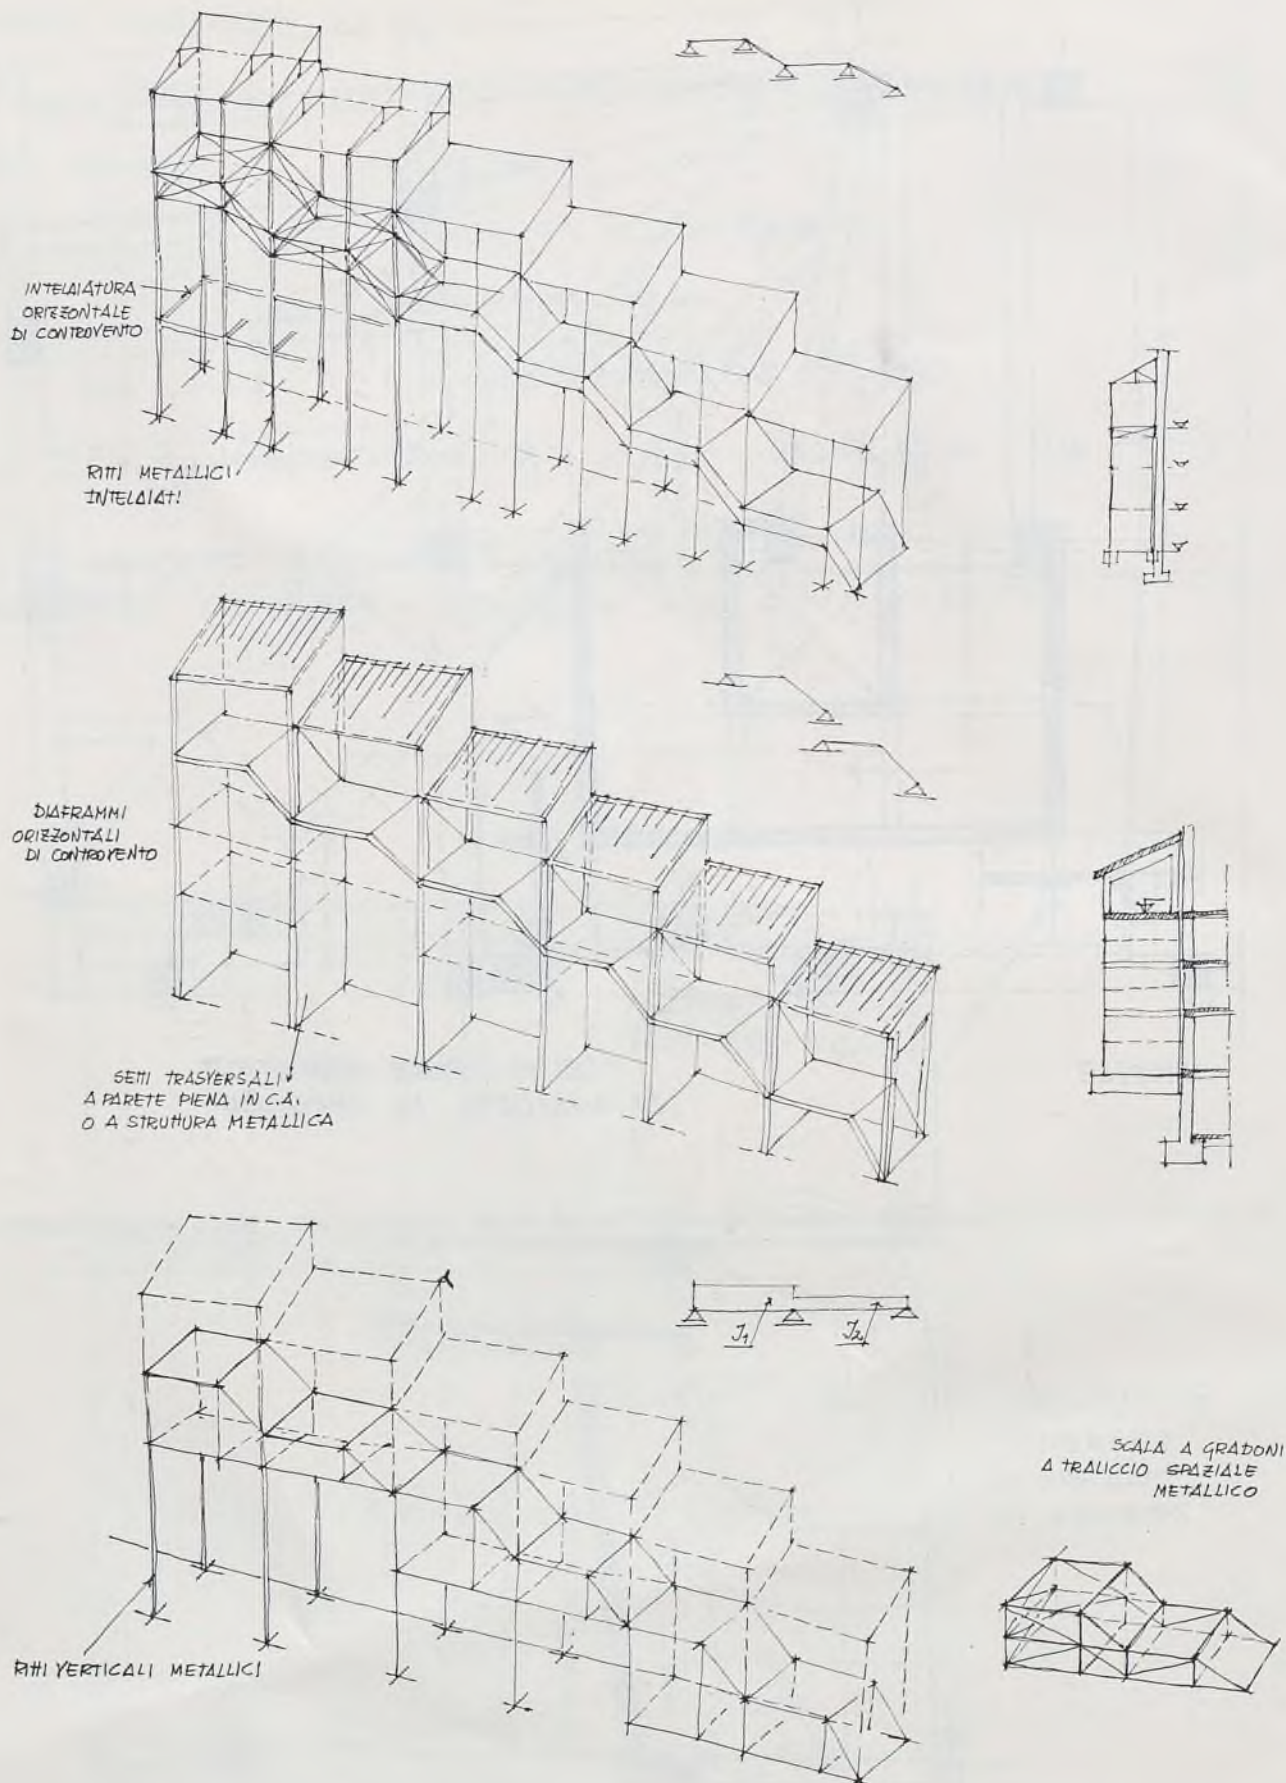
Proposte per la schematizzazione statica e la corrispondente organizzazione strutturale della scala a rampa unica sul fronte interno dell'edificio sulle vie Pavone e Boccardo si propongono alcune soluzioni alternative, in ciascuna delle quali è previsto il raddoppio della struttura portante verticale in aderenza a quella già esistente, l'assoluta autonomia dell'organismo strutturale e adeguati sistemi di controventatura nei piani verticali e nei piani orizzontali.
